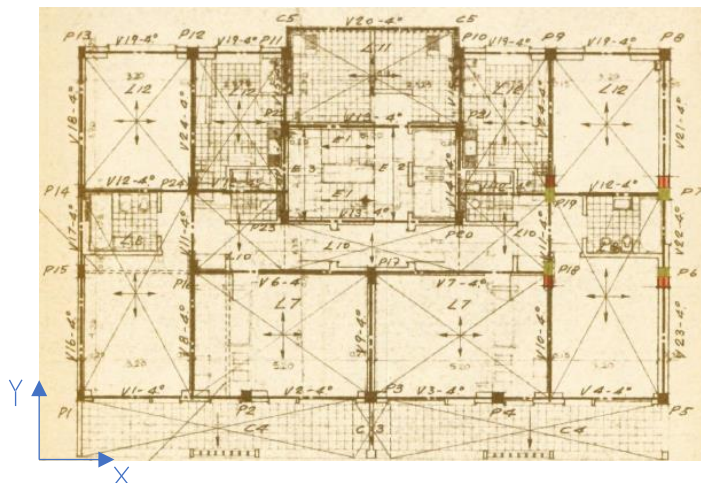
Planta de estruturas: 1º andar; com a identificação das direcções.
